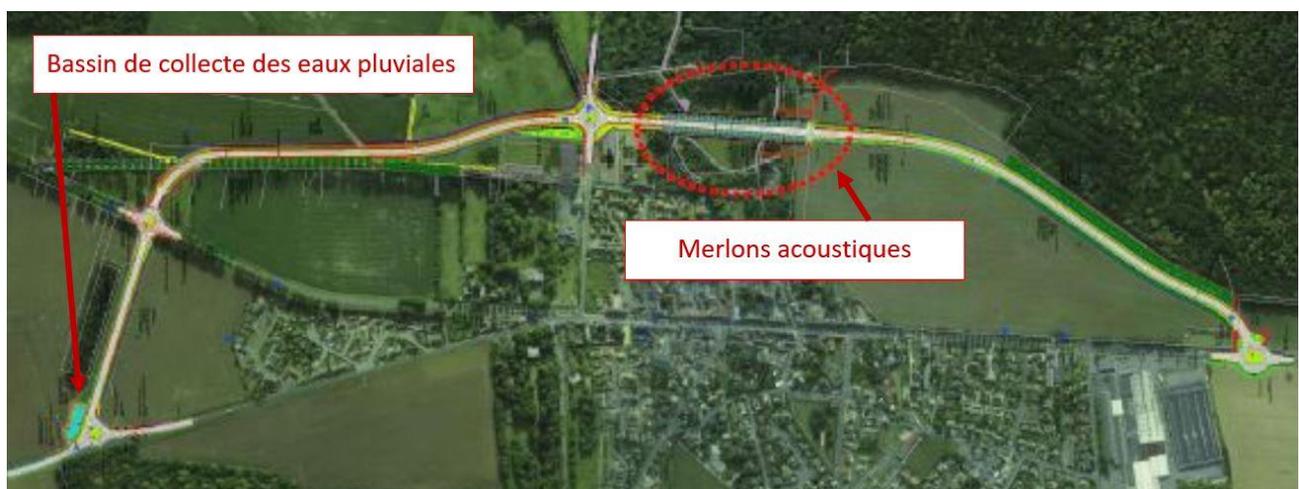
bassin de collecte des eaux pluviales et protections acoustiques (source : dossier)
